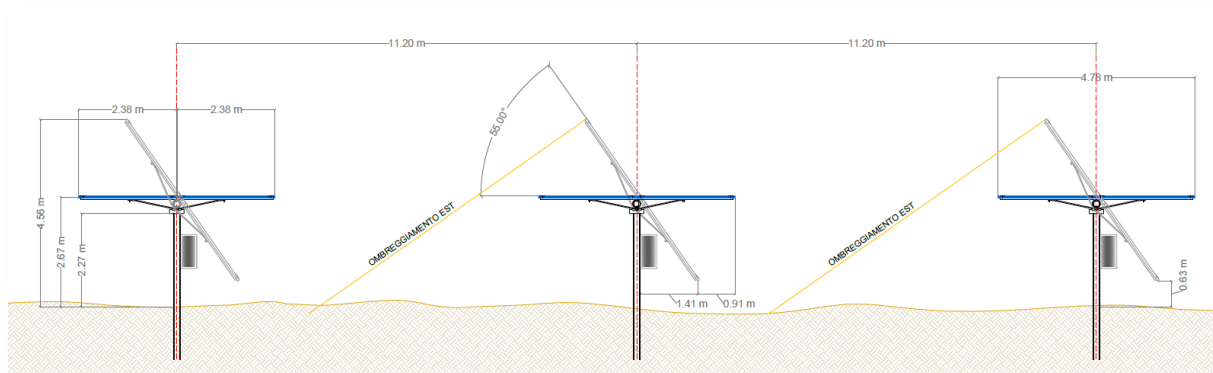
Vista frontale con rotazione di 55° est e distanza longitudinale tra le strutture
